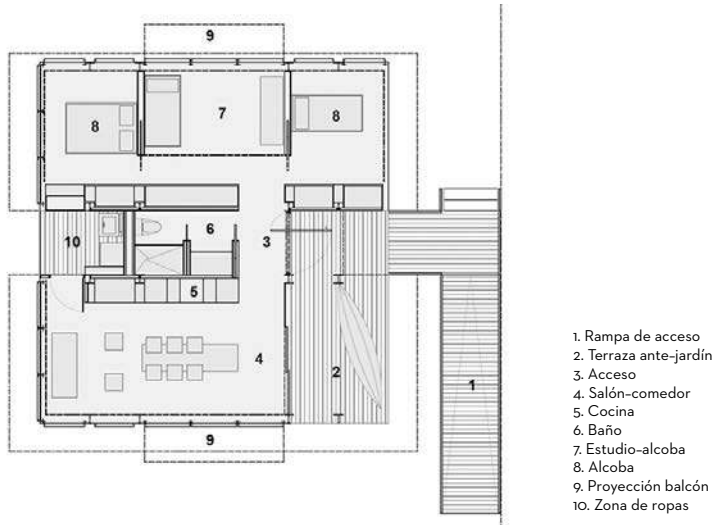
VISTA EN PLANTA DE LA CASA ALERO
